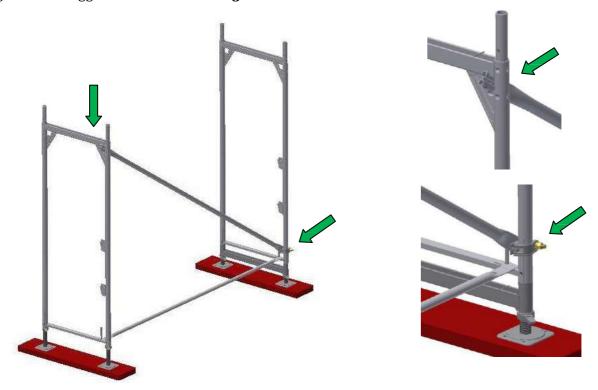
posa di stilate, pavimenti a zero e distanziatori
